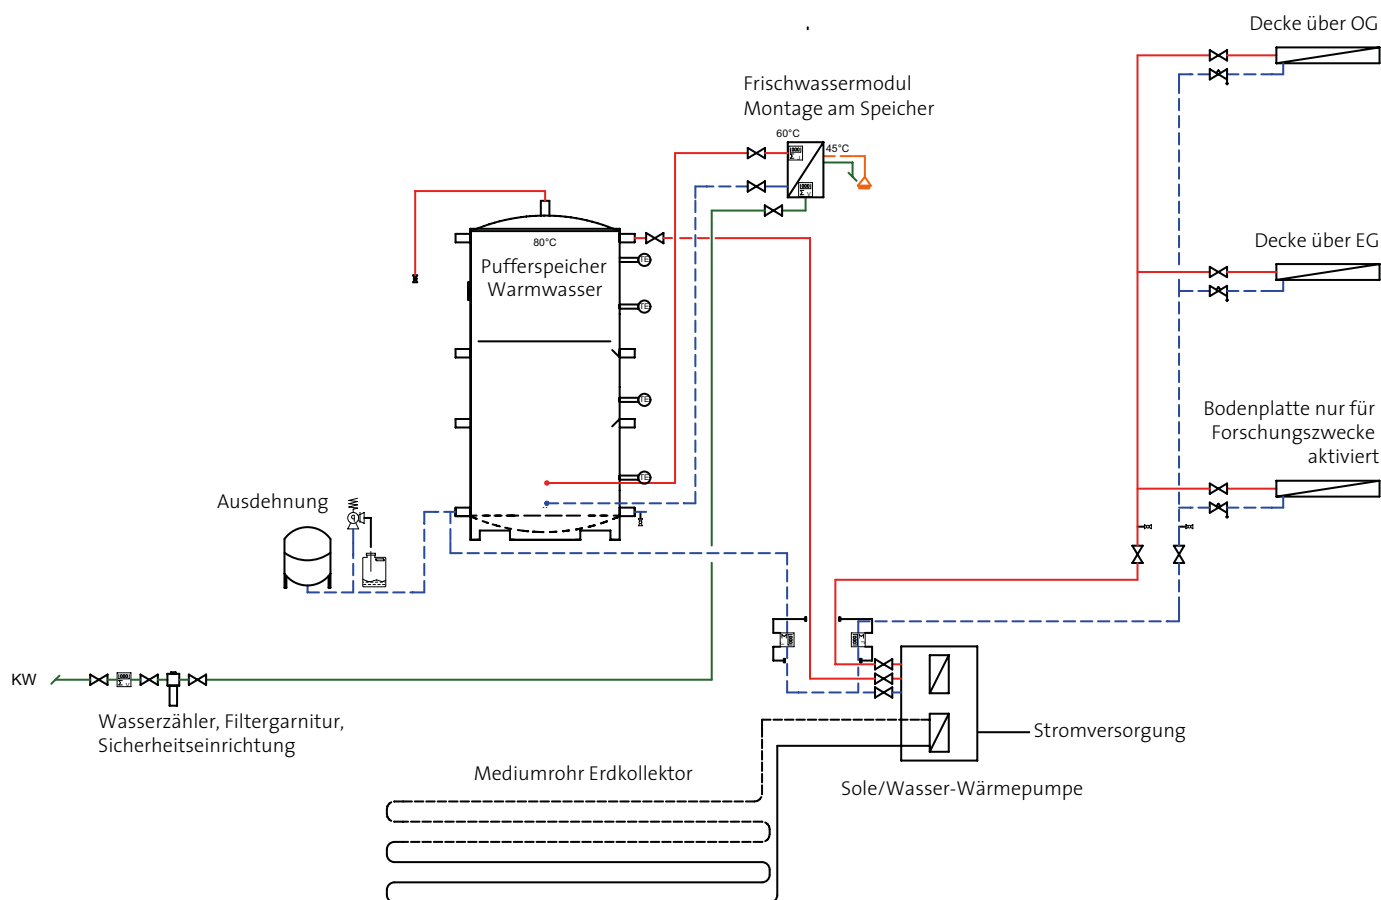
| Prinzipdarstellung Musterhaus, Schema – Heizung, Entwurf.
